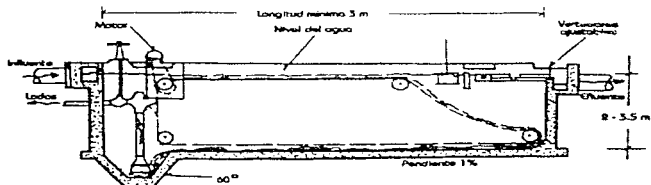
GEOMETRÍA DE UN TANQUE SEDIMENTADOR PRIMARIO DE TIPO RECTANGULAR
